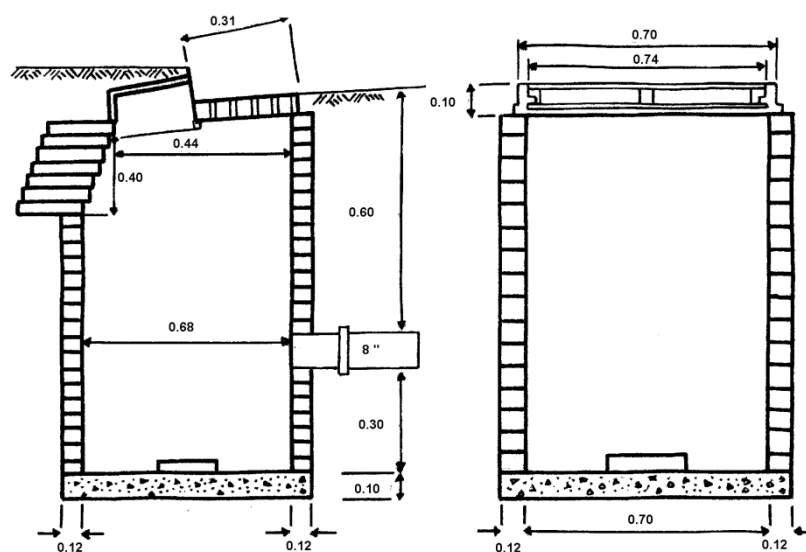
Tragante sin sello hidráulico y con desarenador para alcantarillado de aguas lluvias. Todas las medidas están en metros.
